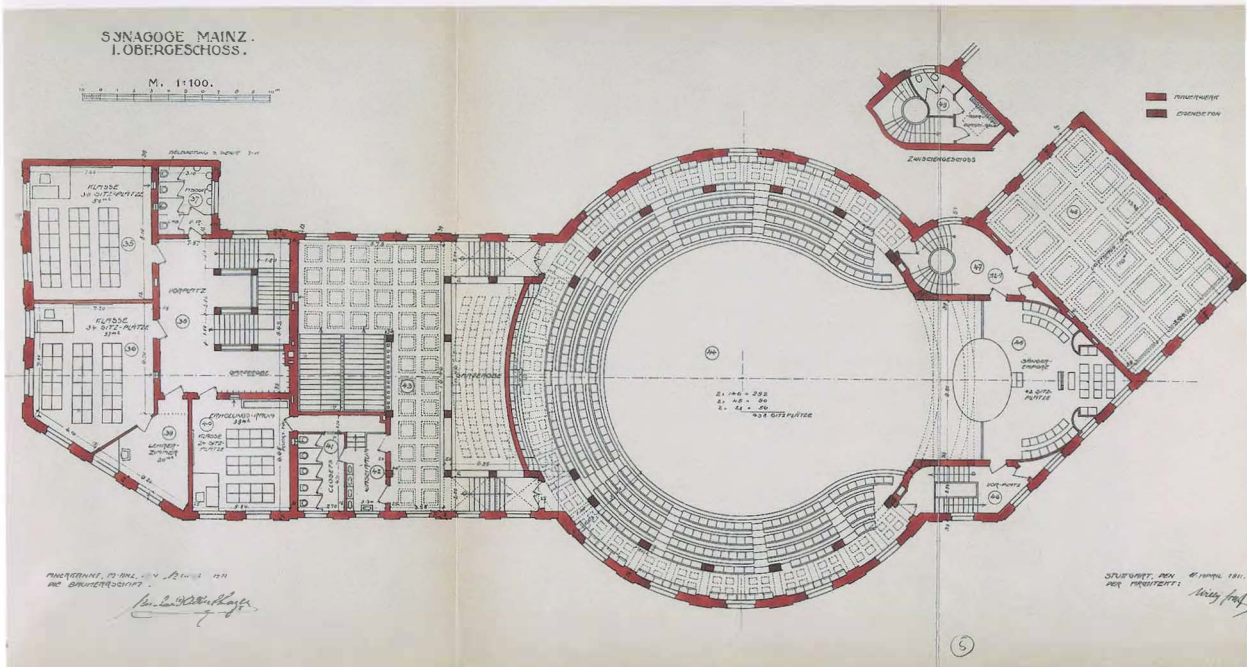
Grundriss Synagoge Hindenburgstraße
